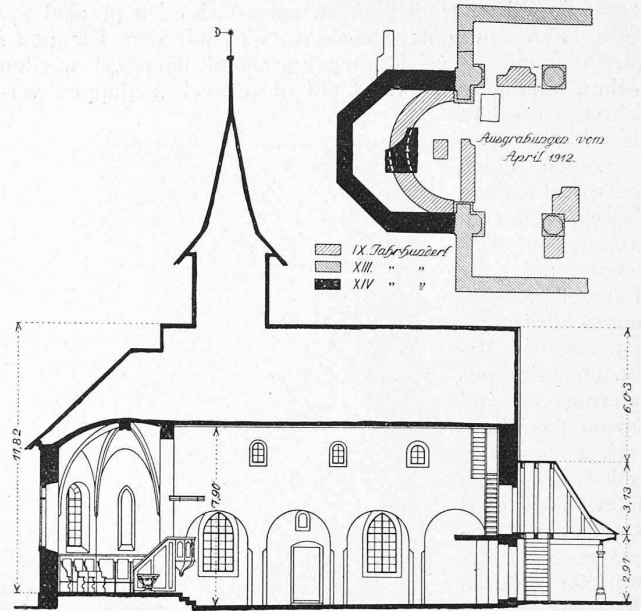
u. 4. Grundriss u. Schnitt. — Abb. 5. Fundamente. — 1 : 400.
